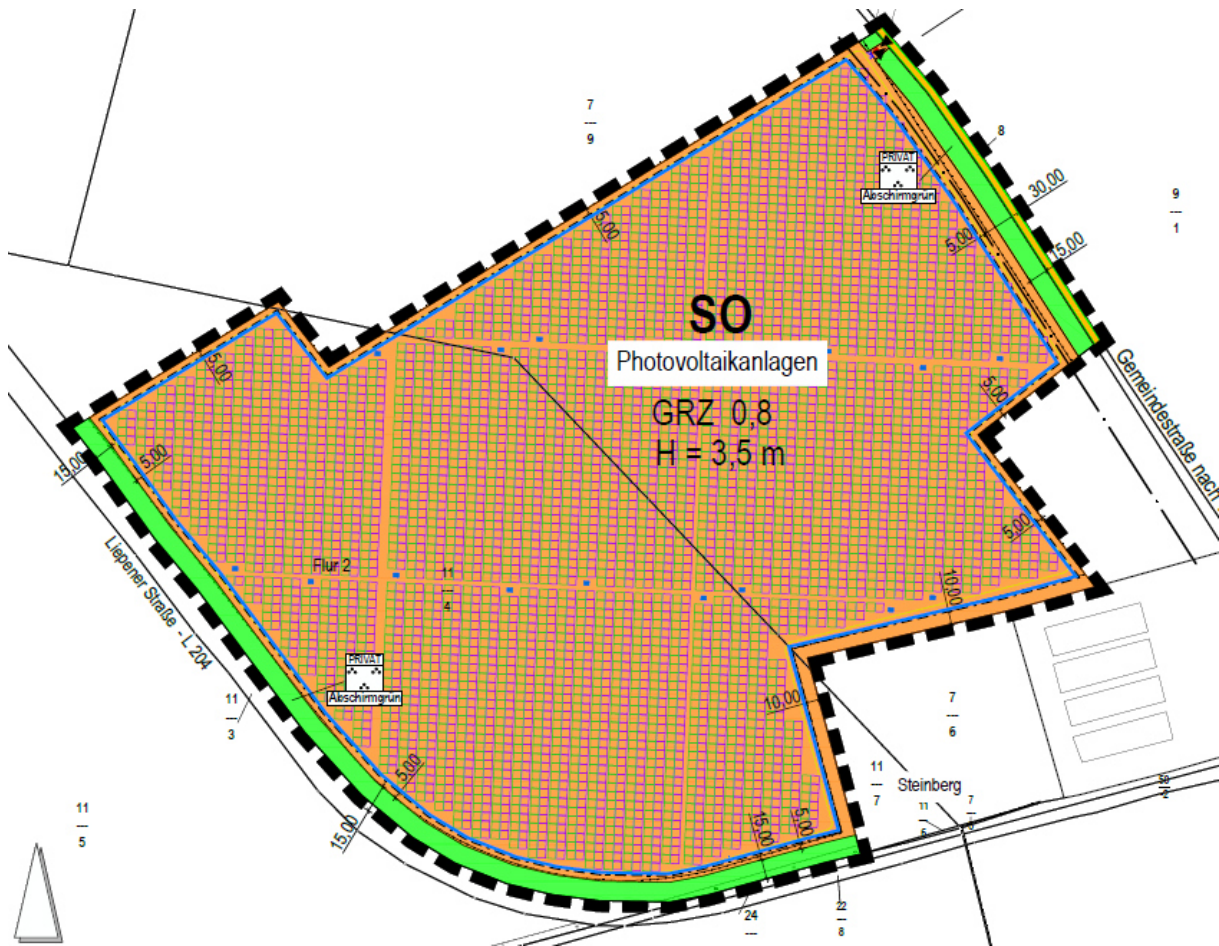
Auszug aus dem Bebauungsplanentwurf (STADTRAUMPLAN 2024) überlagert mit dem Belegungsplans von WI Energy (2024)
